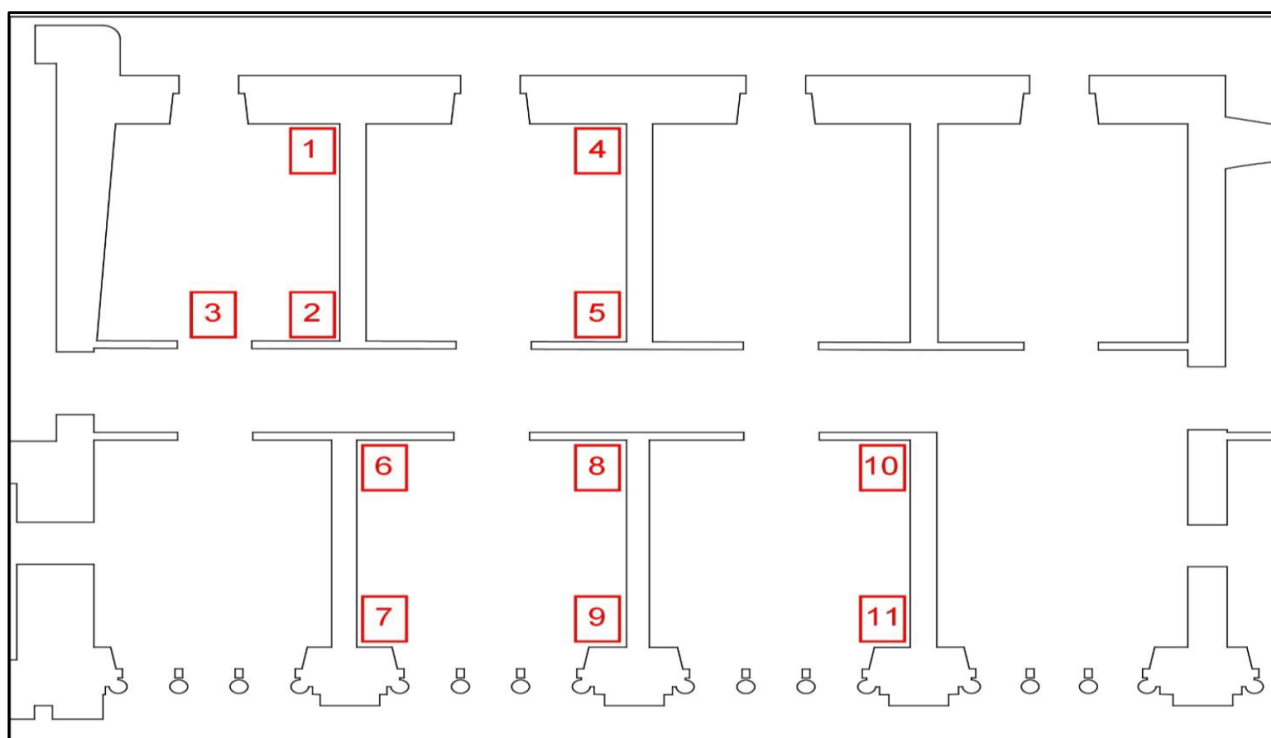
Indicazione dei fori eseguiti sul solaio e pavimento del terzo piano
